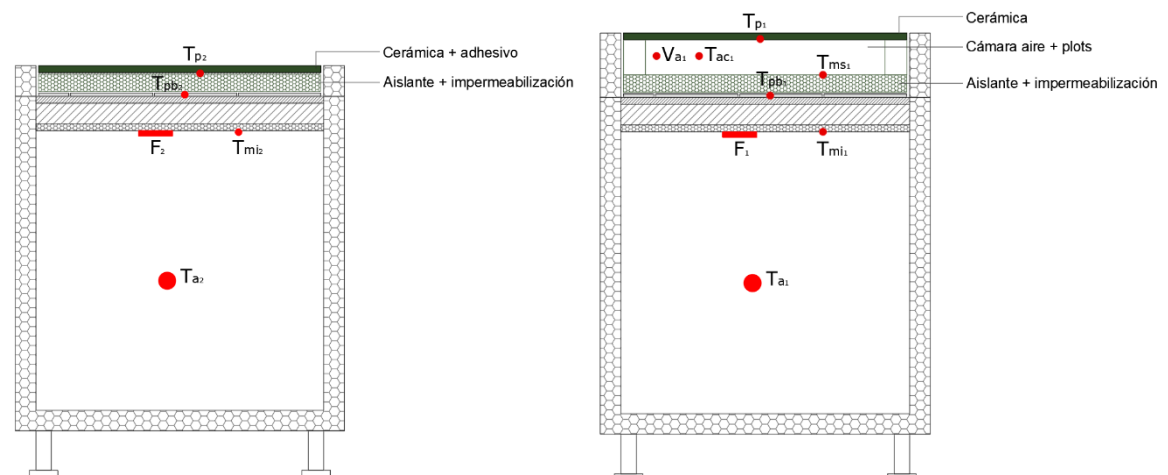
Sistema de rehabilitación mediante aplacado (izq.) y mediante pavimento sobreelevado (dcha.). Secciones transversales con detalles de los sensores.
